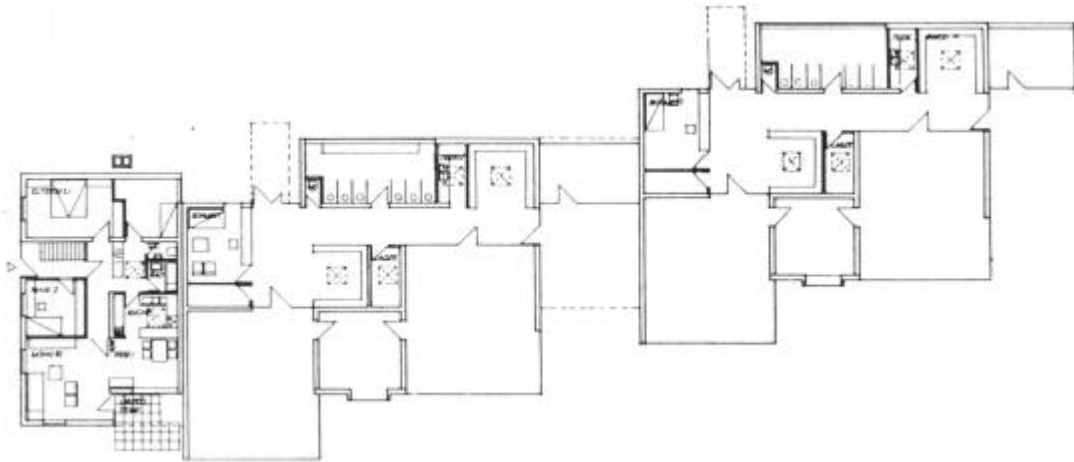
Kindergarten Stuttgart-Fasanenhof, Grundriß ¹
